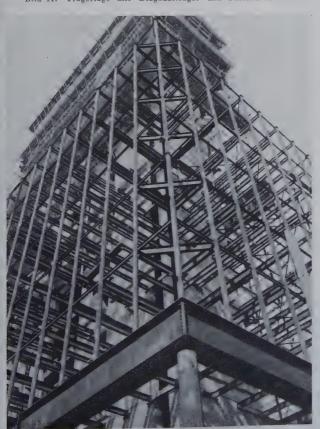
Stützen, Deckenträger und Bockkonstruktion
